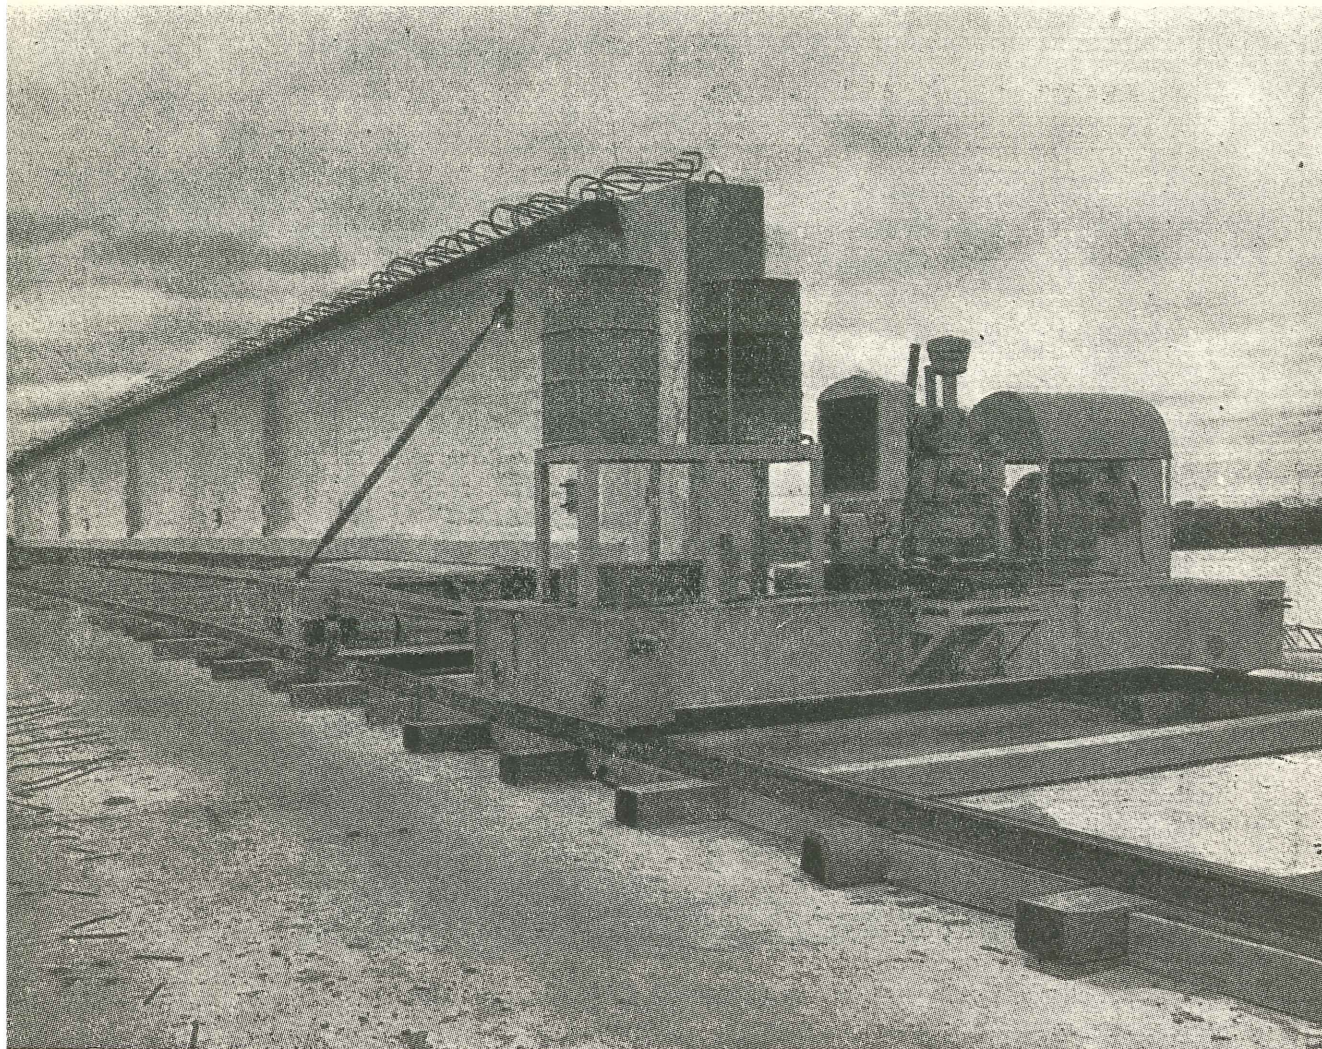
Transporte de una viga pretensada a lo largo de las vías de lanzamiento
